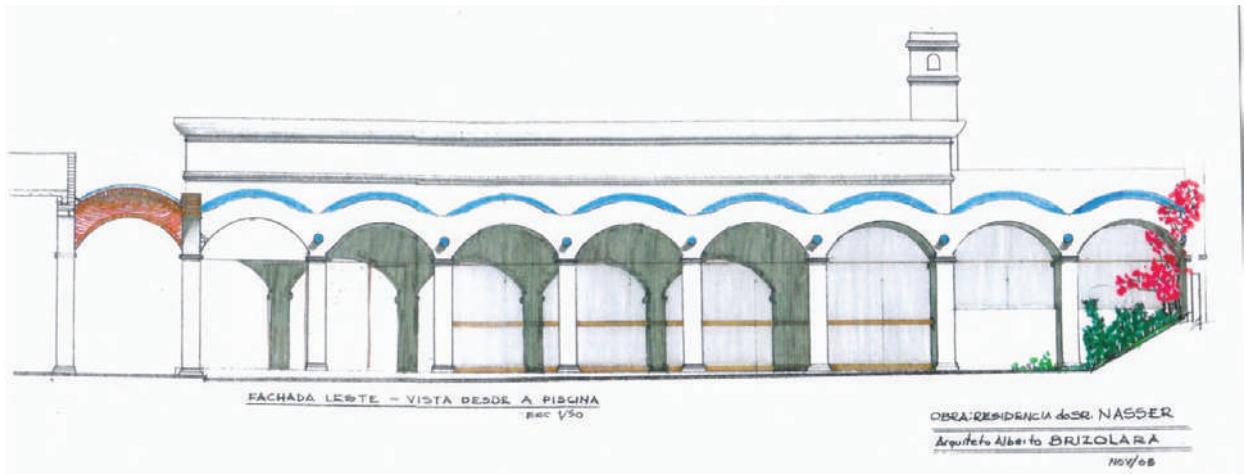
Os arcos e as cúpulas foram feitas sem armadura e sem forma, e as colunas são de tijolo com armadura vertical na junta. (*-5).
